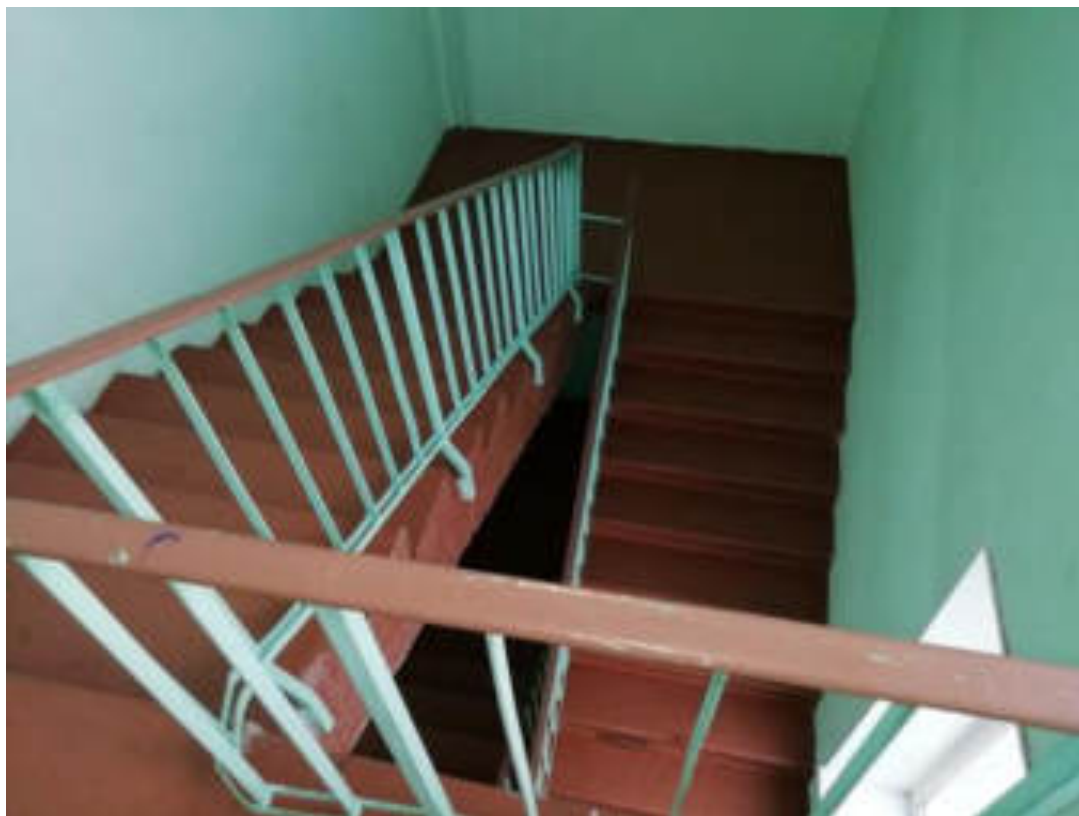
Лестница 2 корпус 2. Железобетонные лестничные марши и площадки
